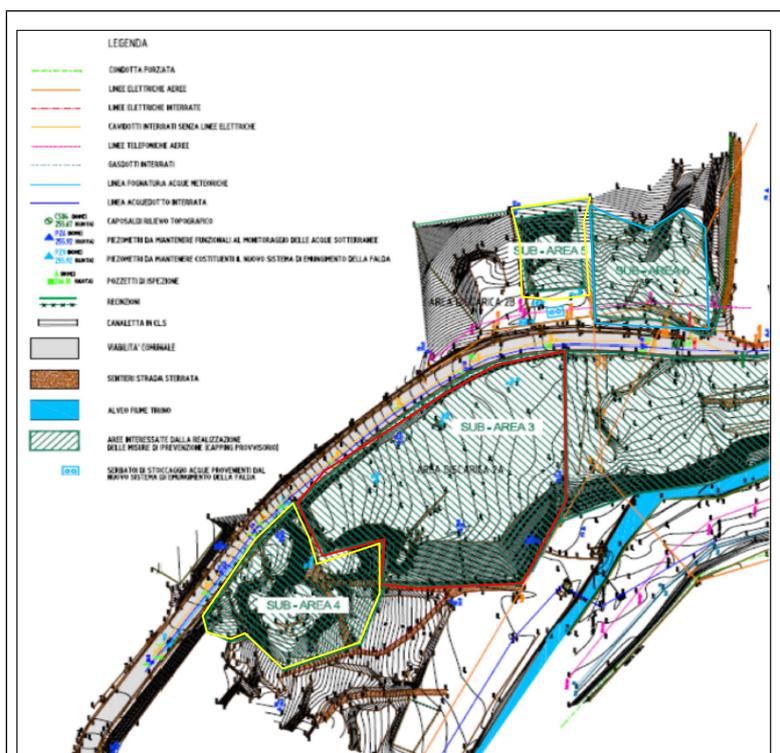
Ubicazione delle aree di intervento – stralcio delle planimetrie di Progetto.
